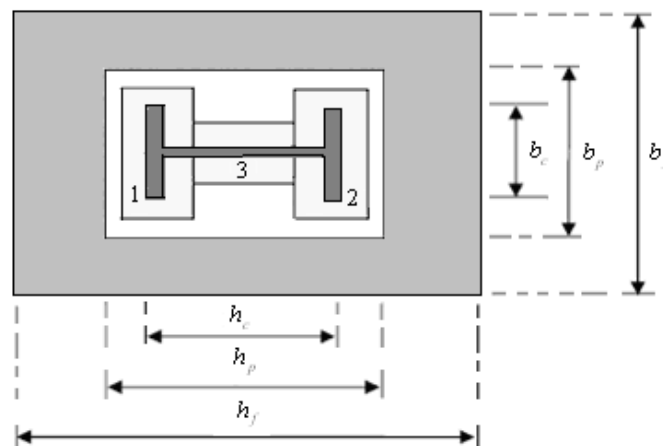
Pieds de poteaux encastré types et emplacements pour les boulons d'ancrage.
